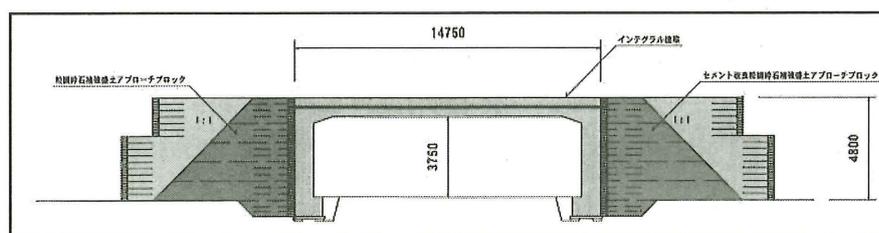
ジオシンセティックス補強土一体橋梁試験施工断面図
